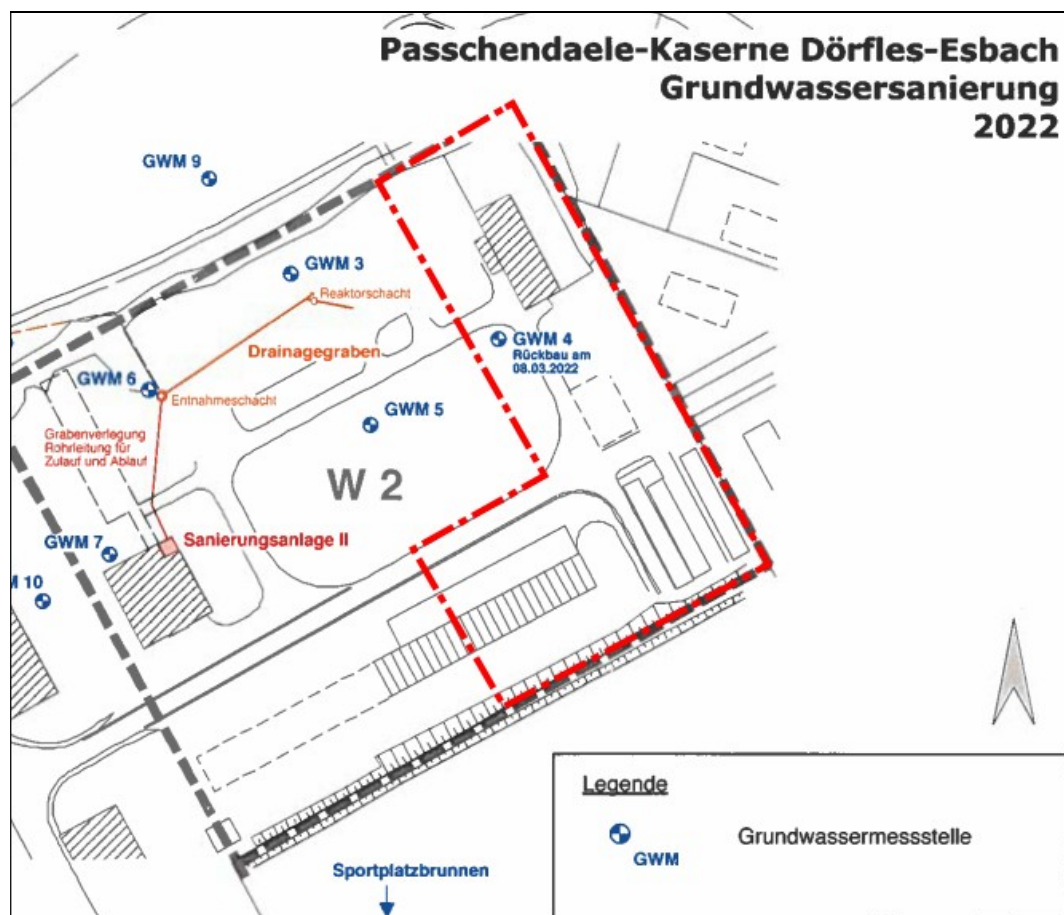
Ausschnitt mit Lage Grundwassermessstellen
